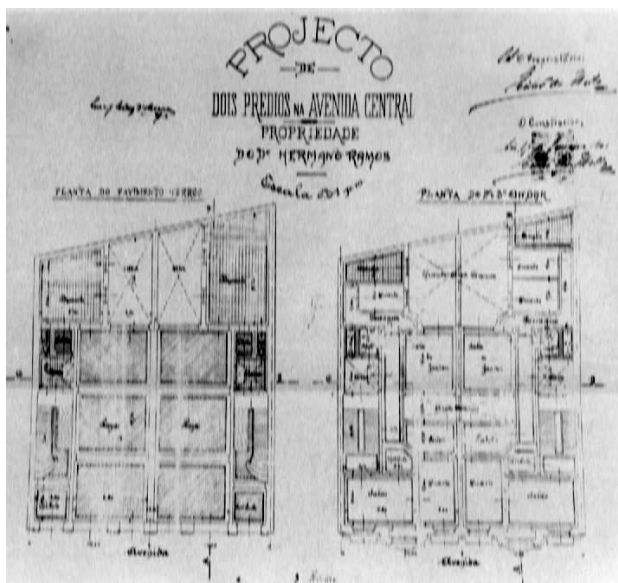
Planta baixa primeiro e segundo pavimentos do Edifício do Sr. Hermano da Silva Ramos: Fonte: Arquivo Nacional.
